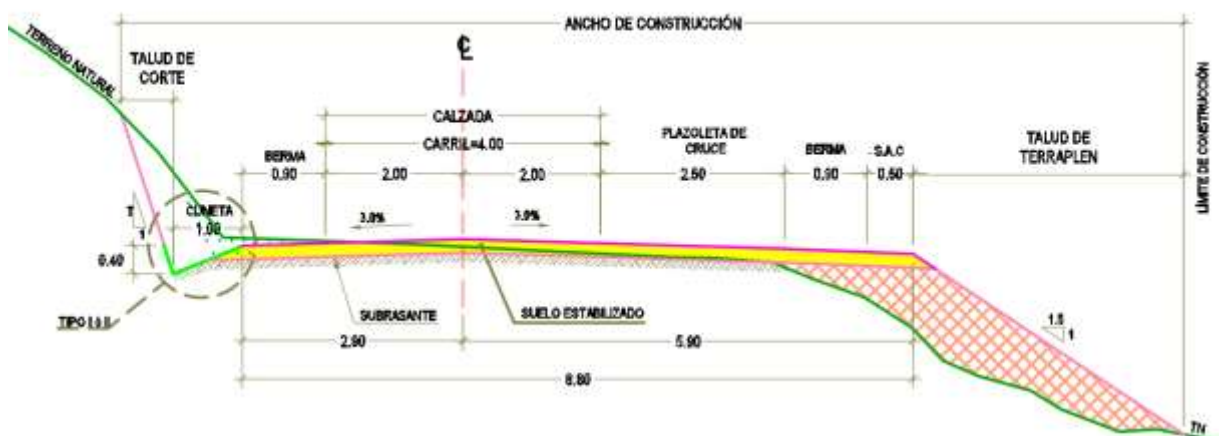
Sección típica con plazoleta de cruce lado derecho. Fuente: Plano de secciones típicas.
